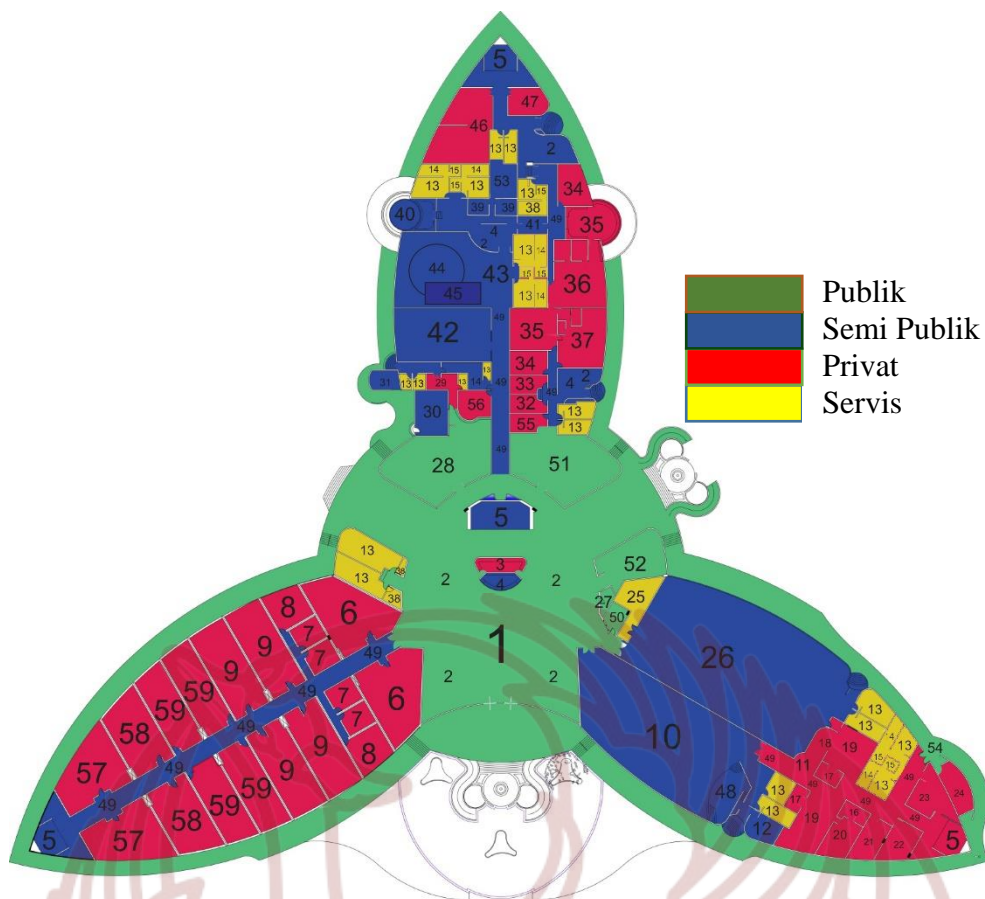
Zoning Grouping Lantai 1, Alternatif 1
